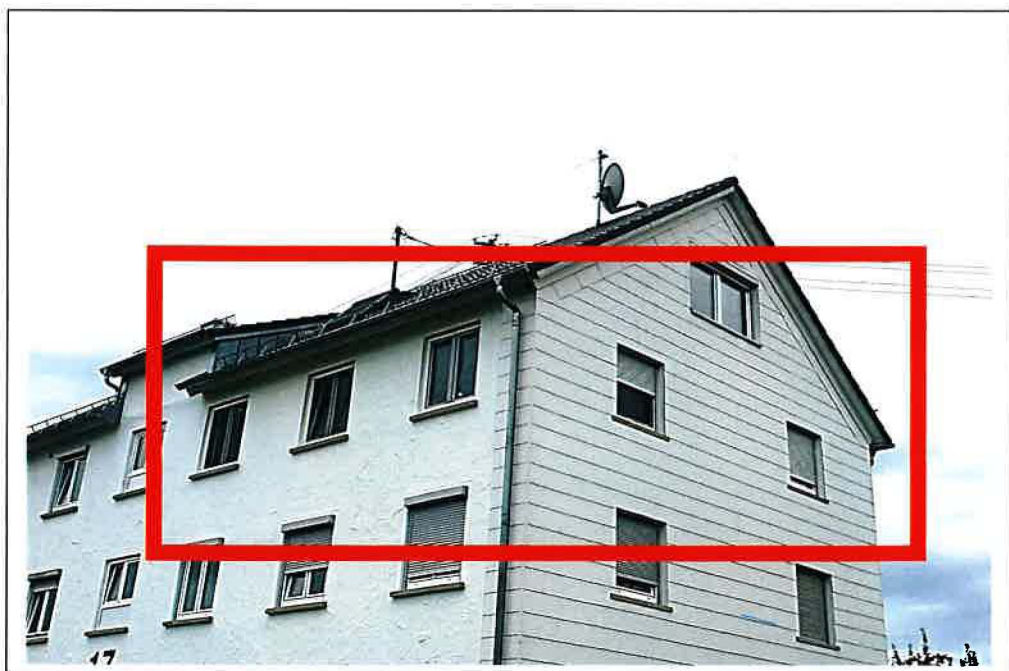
89250 Senden, Ruländerstraße 17. Ansicht Nordwest
